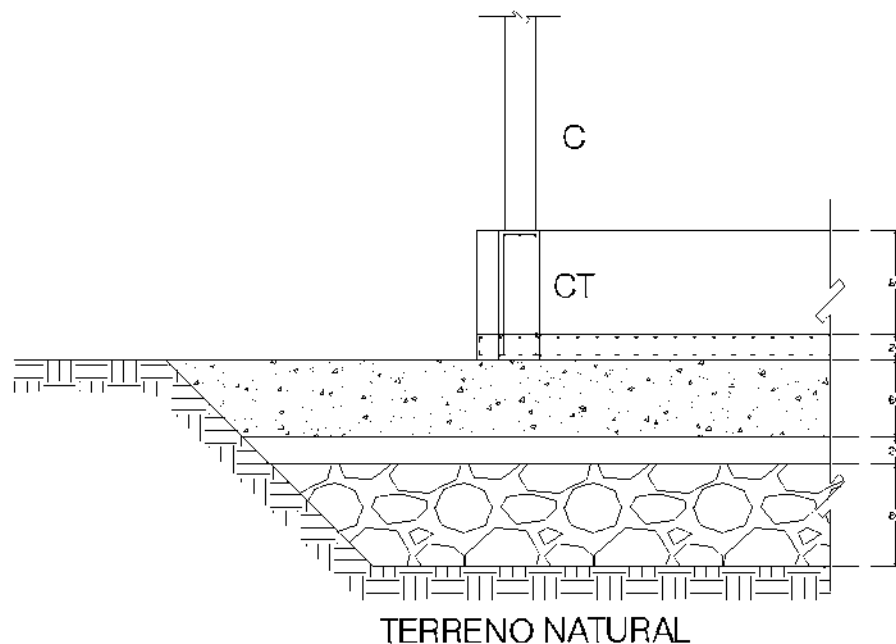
Detalle de lo que era la losa de cimentación del proyecto original.
